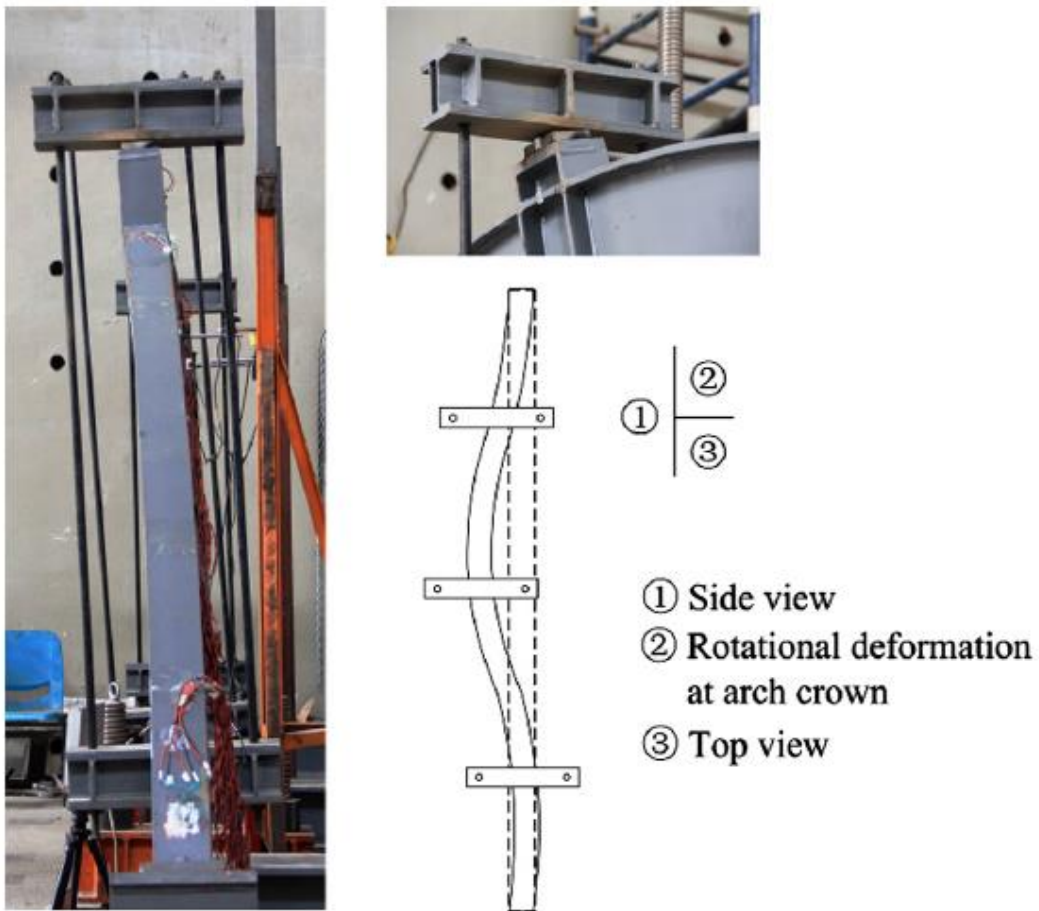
Mode de flambement hors plan de spécimens N°1.
